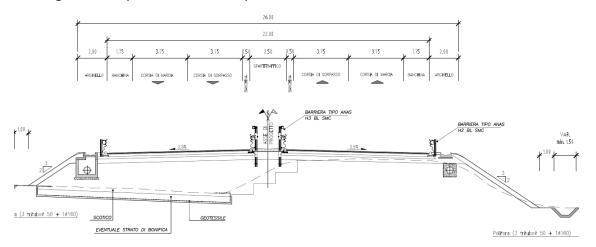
Sezione tipo B in rilevato (DM 05/11/2001)
